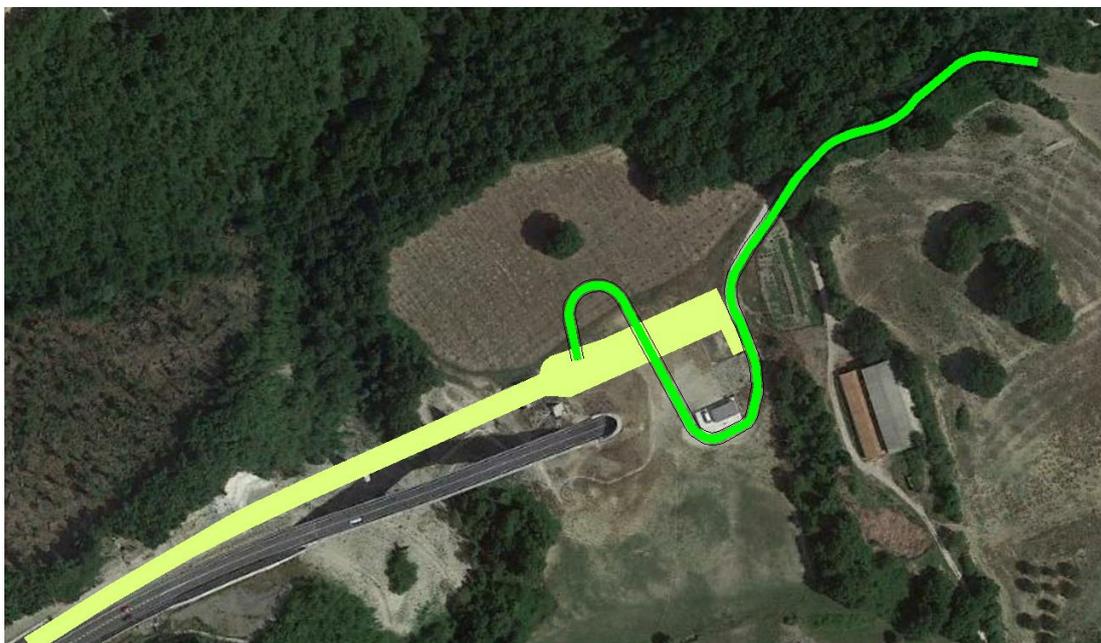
Stralcio ortofoto cantiere operativo Tre Vescovi.
